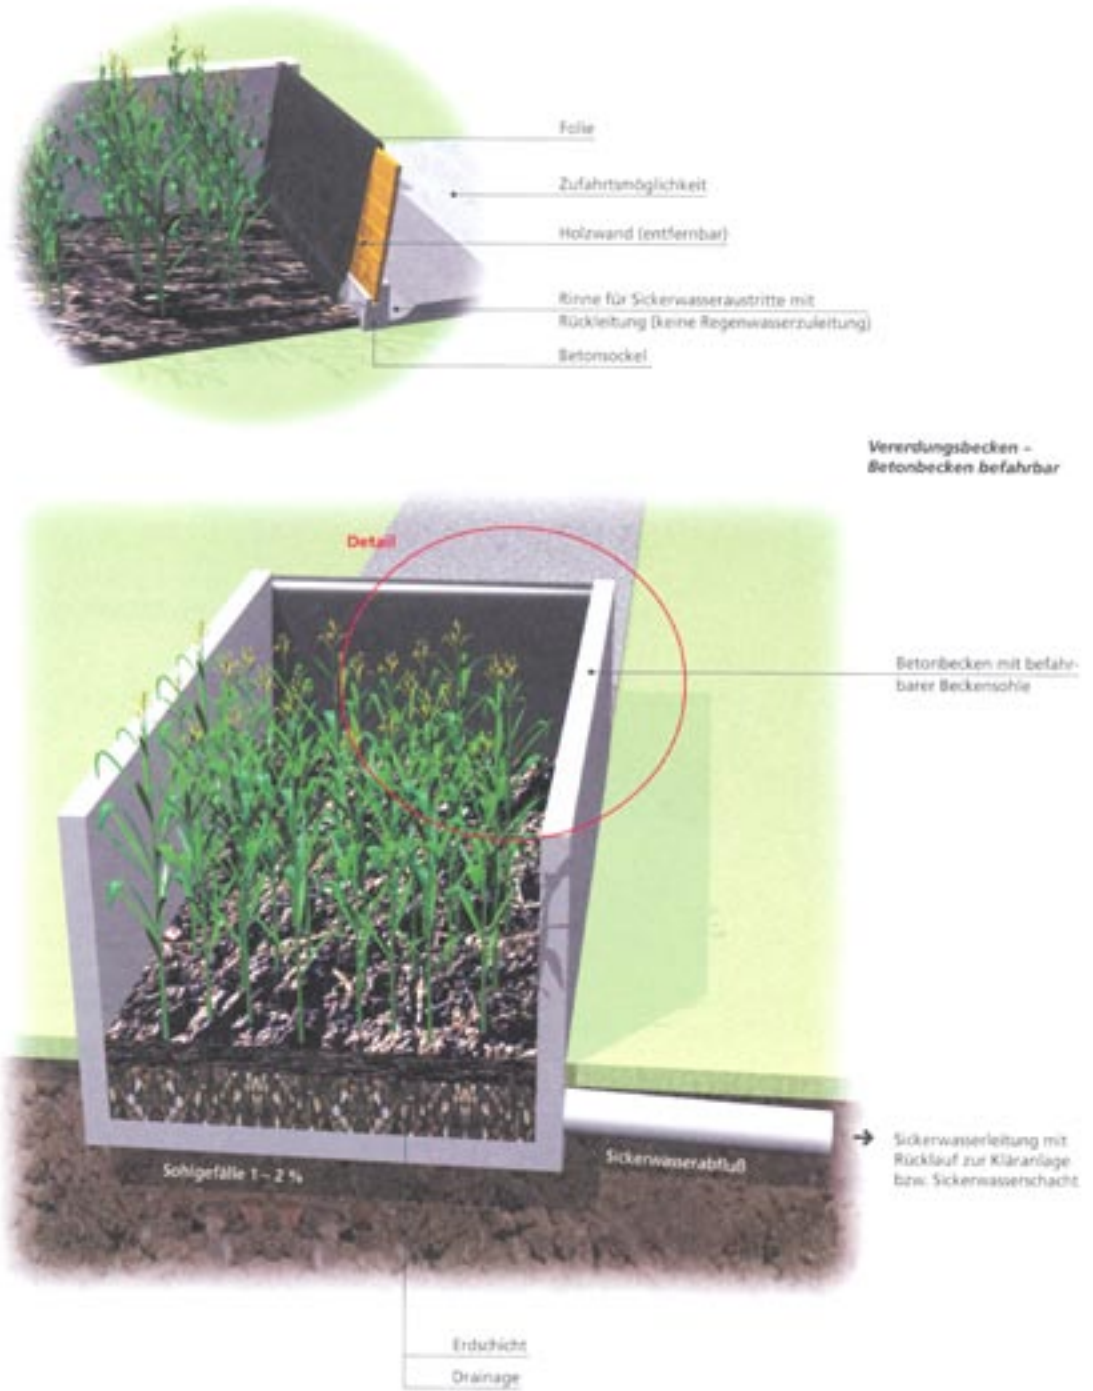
Befahrbares Betonbecken mit Einfahrtsrampe und Becken mit entfernbarer Wand
